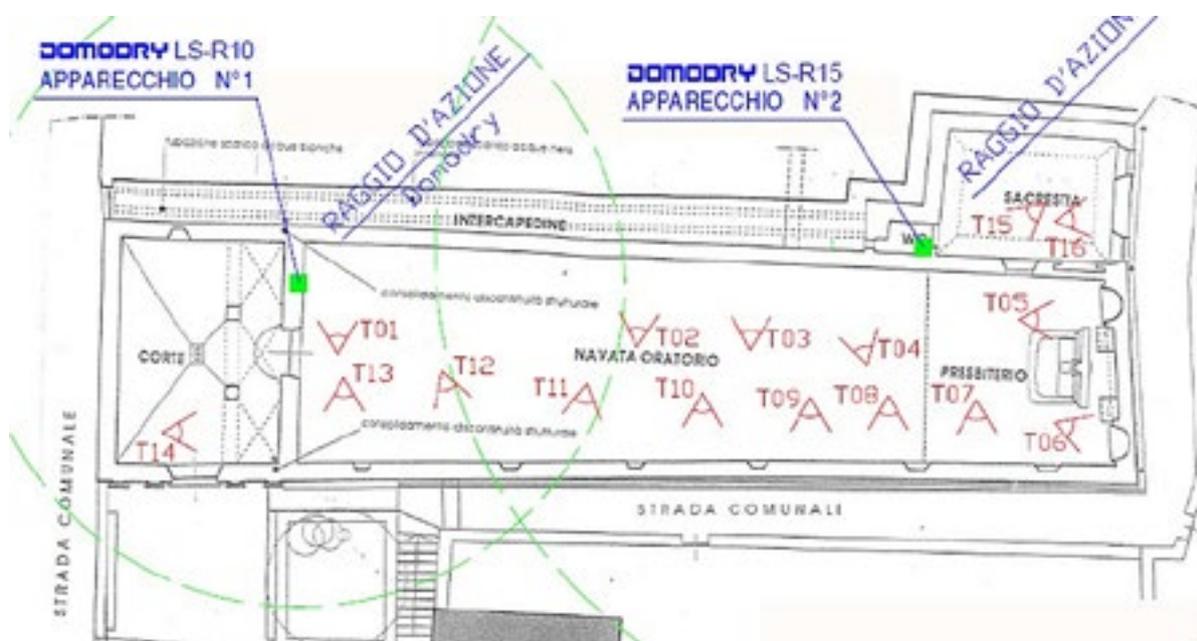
Schema dell'impianto Domodry con ubicazione in pianta delle prove effettuate (termografie all'infrarosso).
